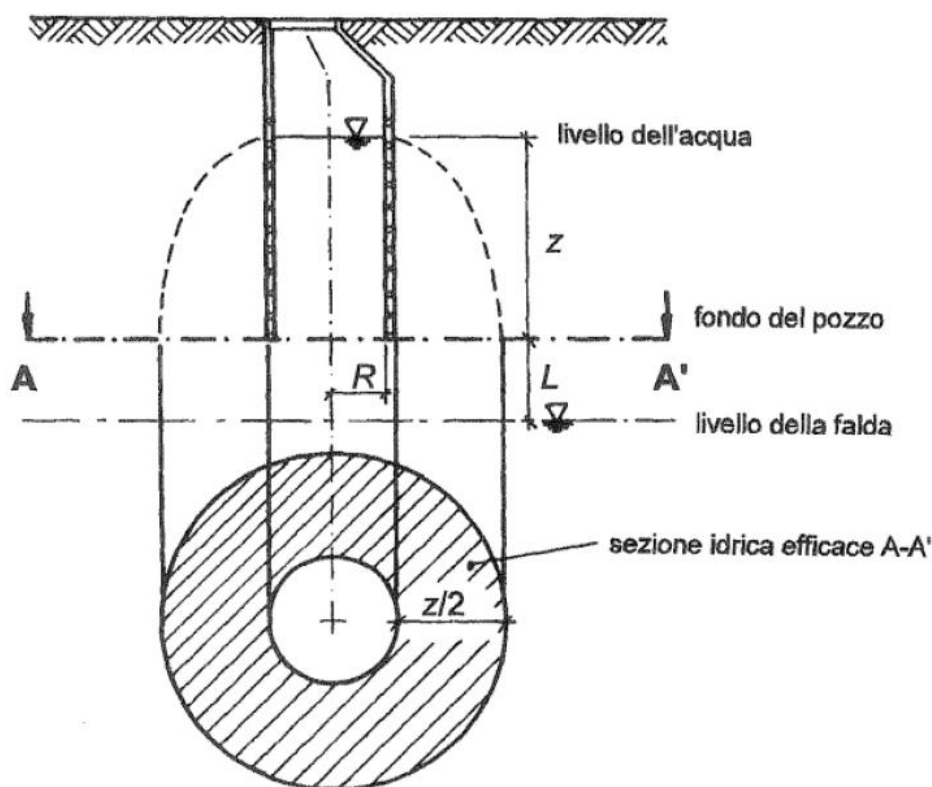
Sezione e planimetria tipo di un pozzo perdente
